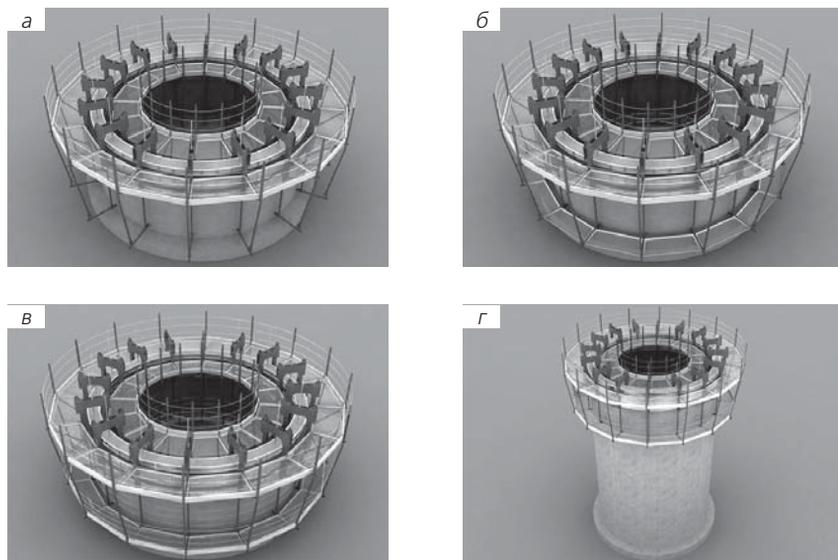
Технологическая последовательность монтажа нижних внутренней и наружной рабочих площадок (а – фиксация вертикальных тяг для монтажа нижних рабочих площадок; б – то же настила нижних рабочих площадок; в – установка перил ограждения нижних рабочих площадок)
